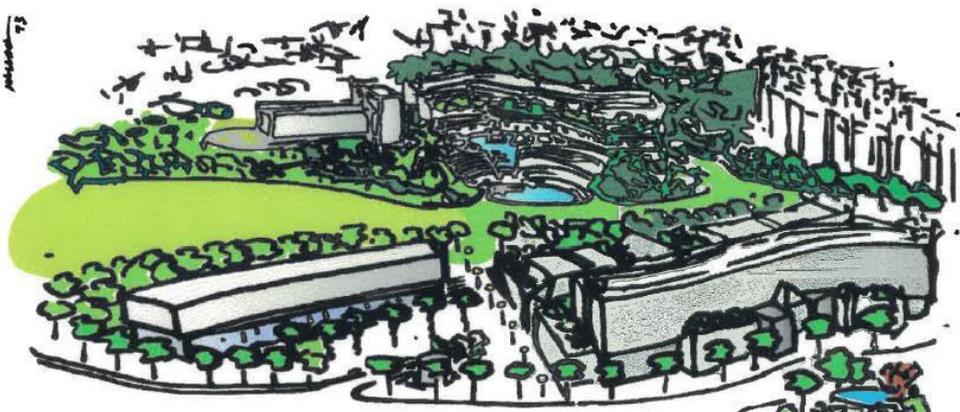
Ilustração do Plano de Pormenor do Moinho das Antas.
